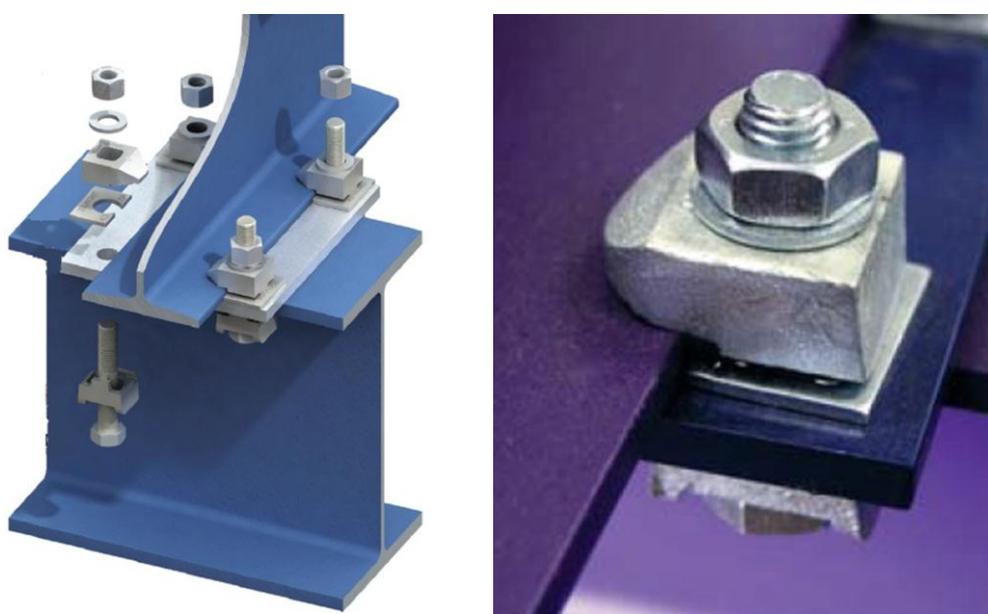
(a) Componentes da ligação Girder clamp. (b) Detalhe da ligação.
